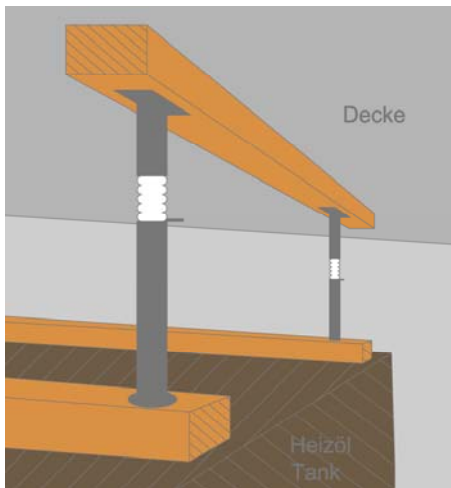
Gegen die Kellerdecke abgestützter Öltank, um Auftrieb zu verhindern (Quelle: Aller); aus [9]
